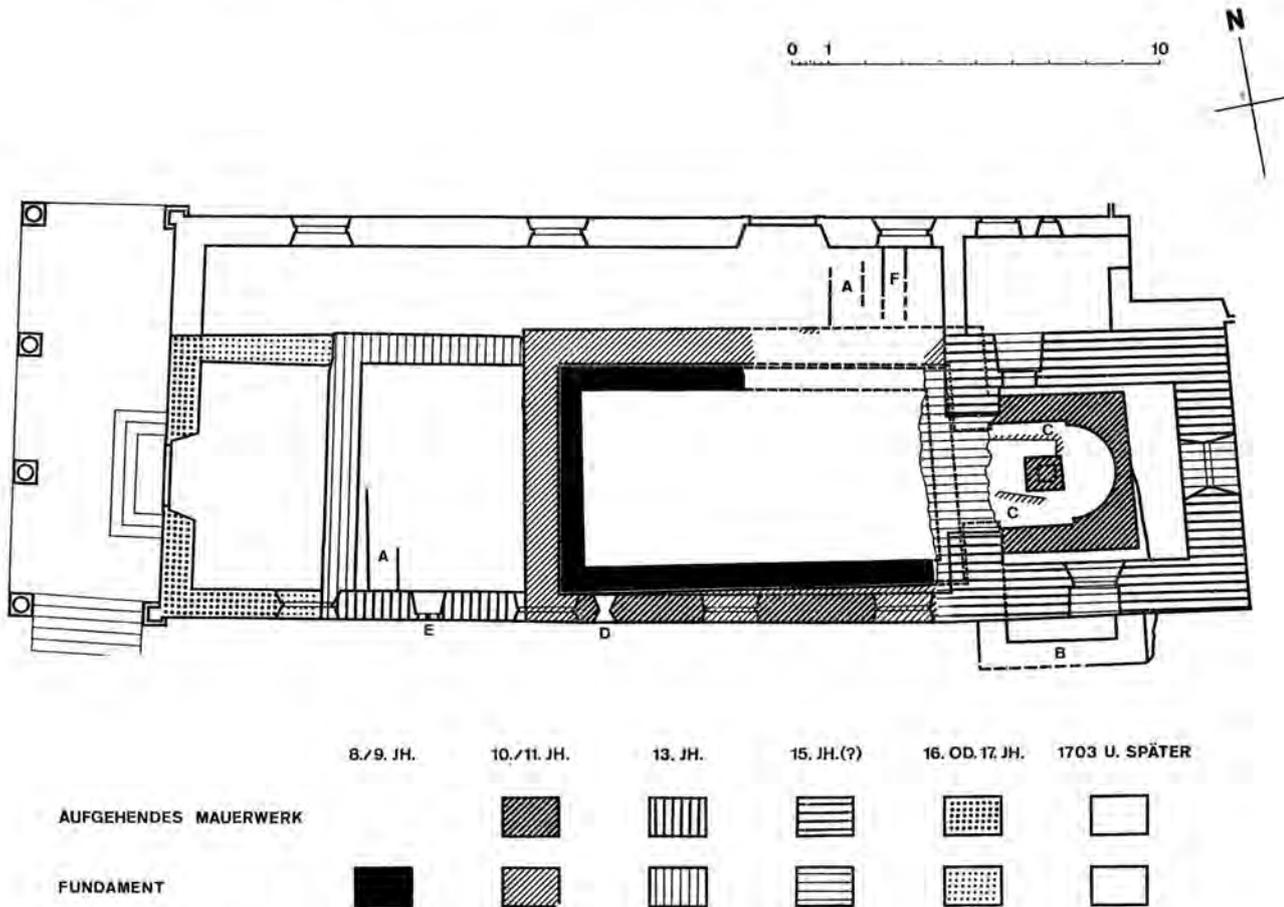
Zürich ZH, Kirche Höngg. Bautappenplan. - 1:200.
